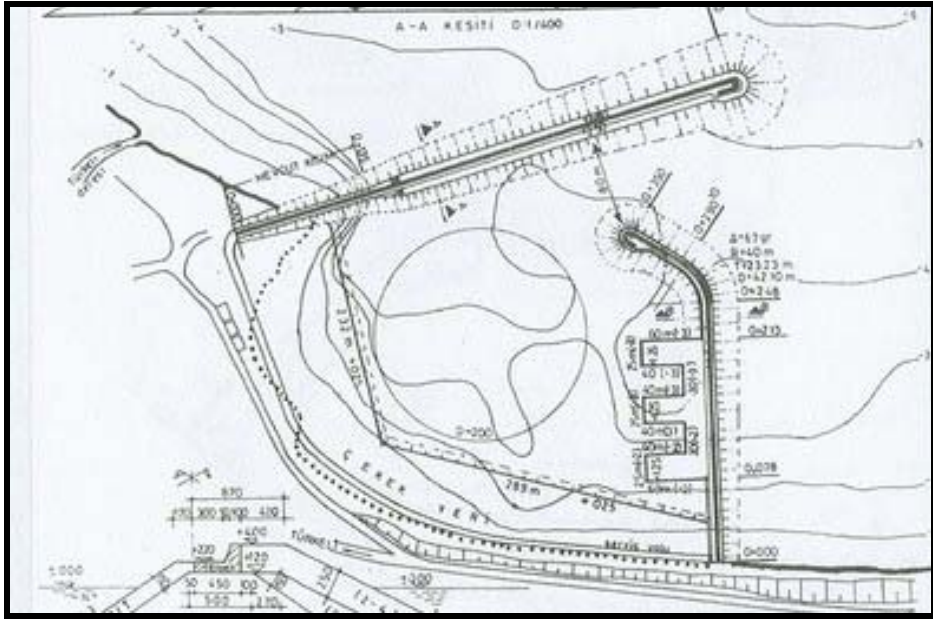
Güzelkent Balıkçı Barınağı planı
